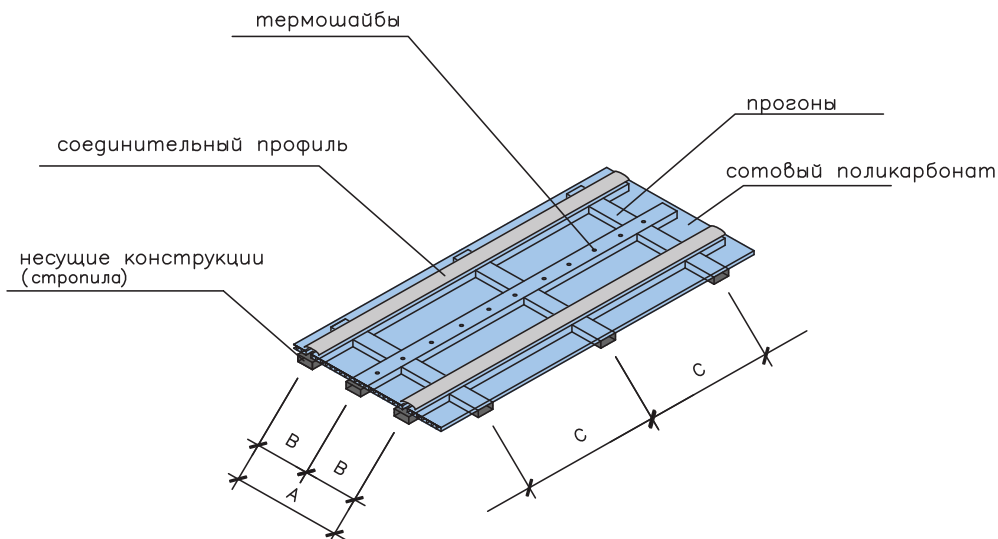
Схематическое изображение типичного способа «обшивки кровли» в арочной конструкции.
